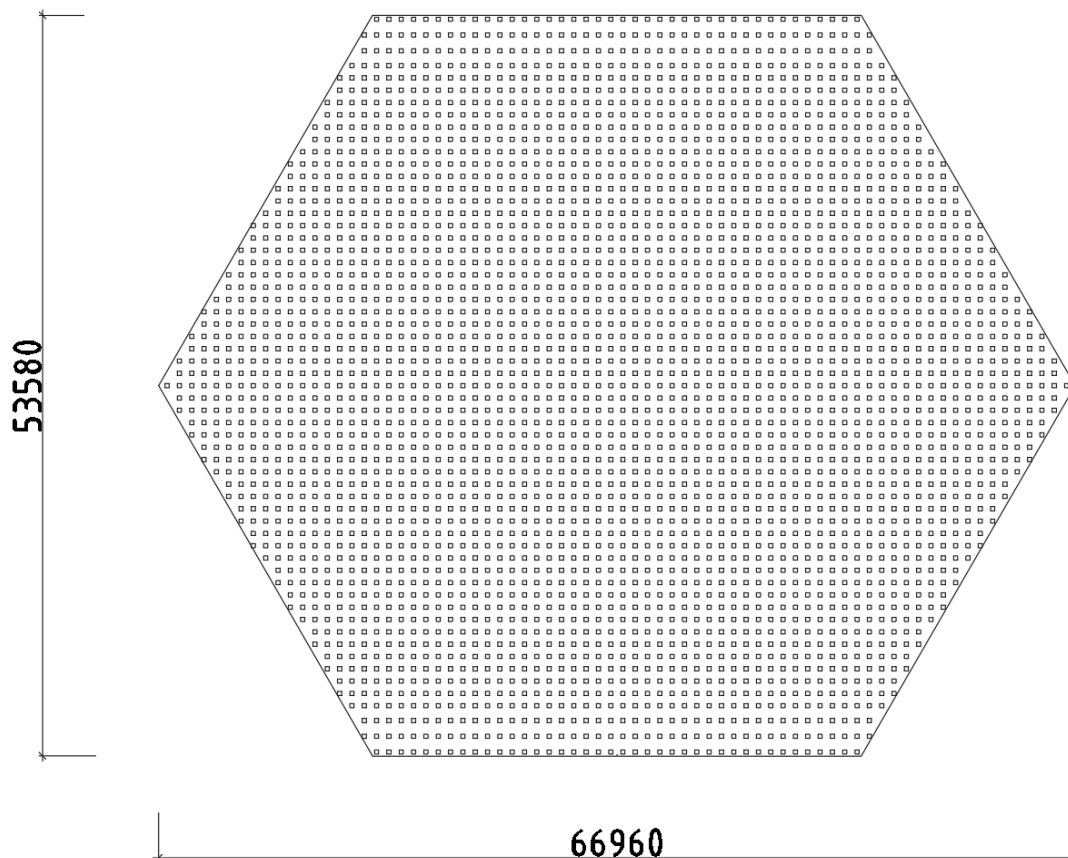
Опалубочный чертеж монолитной плиты фундамента
